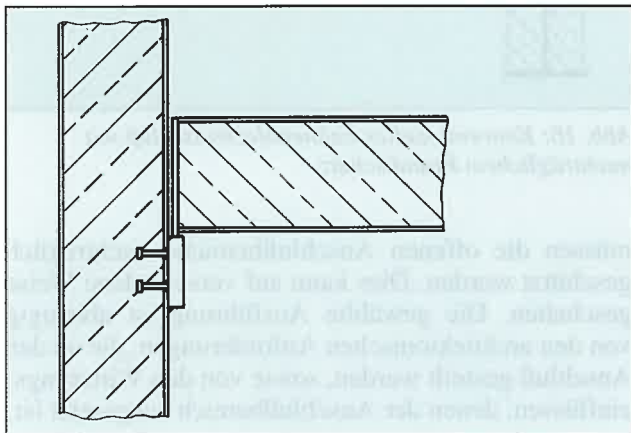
Knaggenanschluß mit untenliegender Knagge und Rückverankerung im Beton der Stütze
